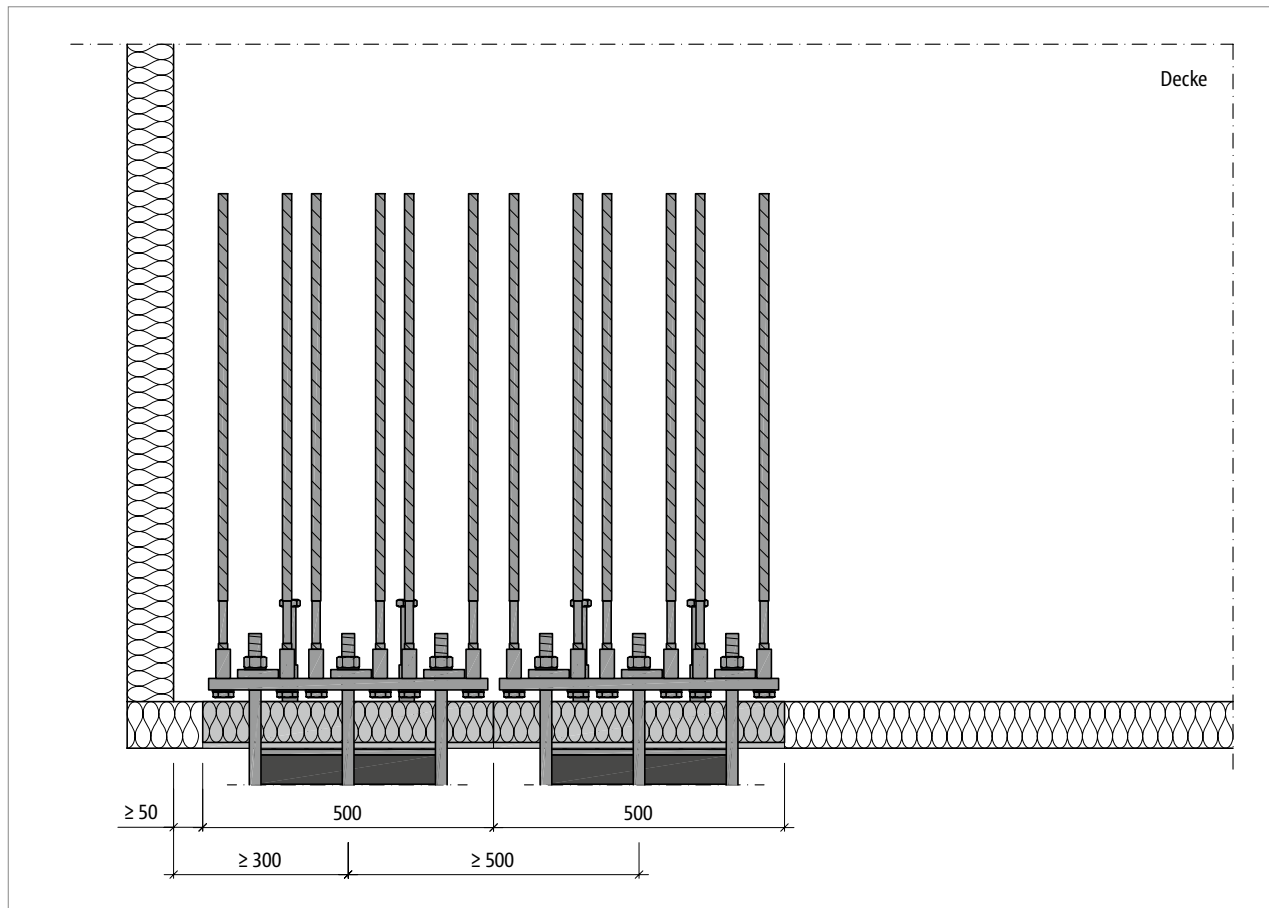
Schöck Isokorb® IQ Typ K-A: Randabstand und Achsabstand
